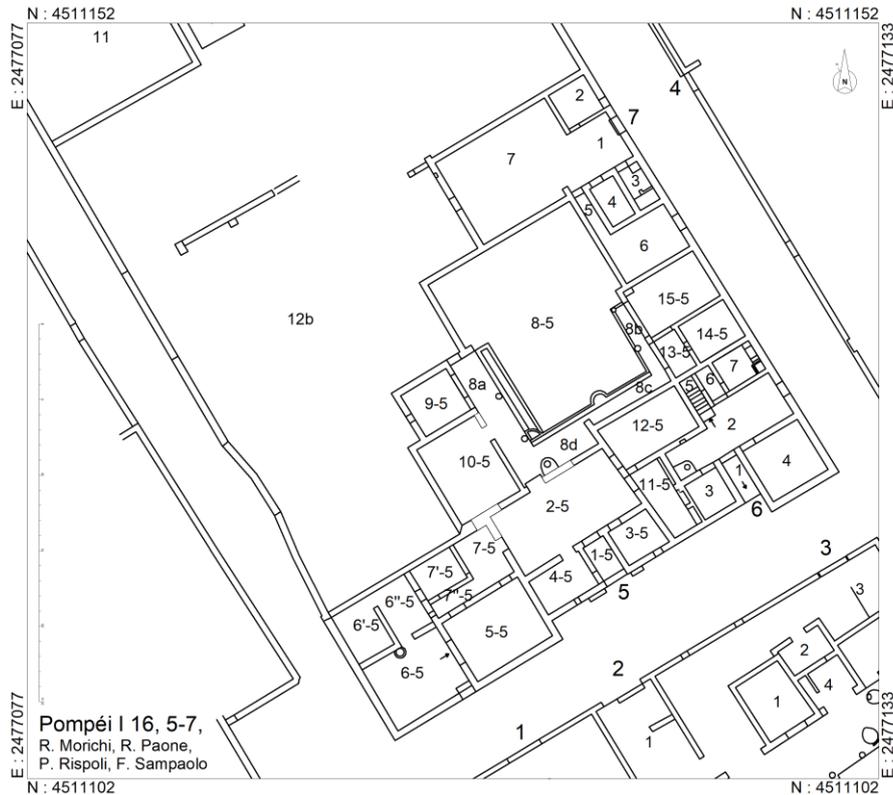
Planimetria del settore meridionale dell'insula I 16.
